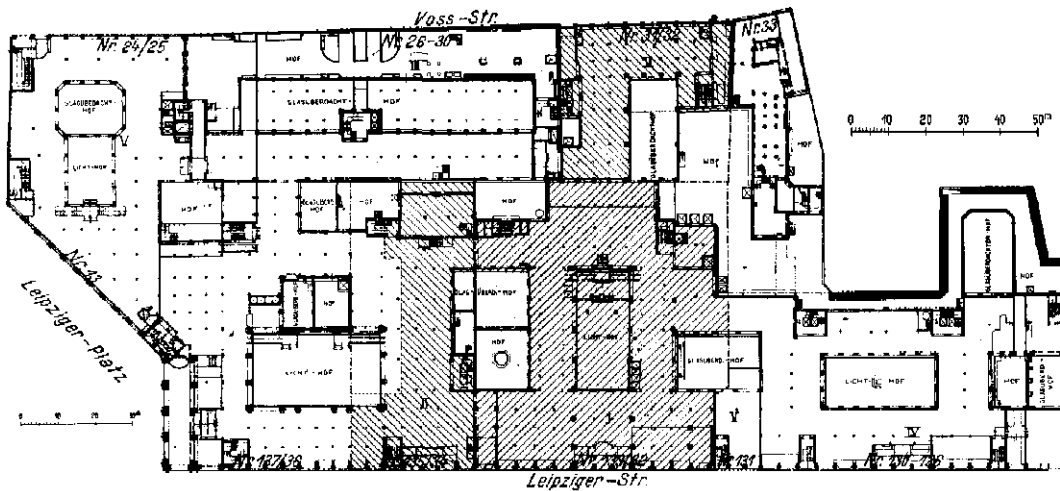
| Warenhaus Wertheim, Berlin | Gesamtgrundriß 1:2000 | Erdgeschoß | Vgl. Abb. 5 und 10
